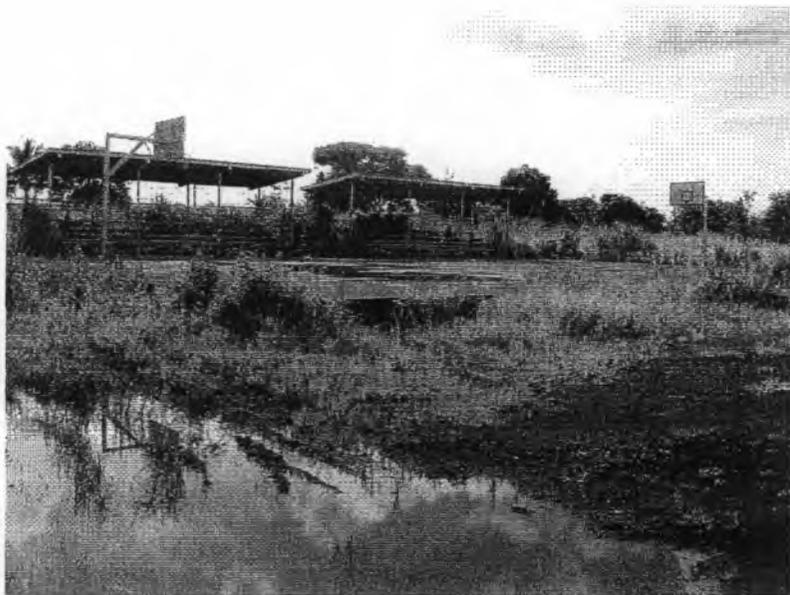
Vista desde el terreno hacia la entrada Versalles I
